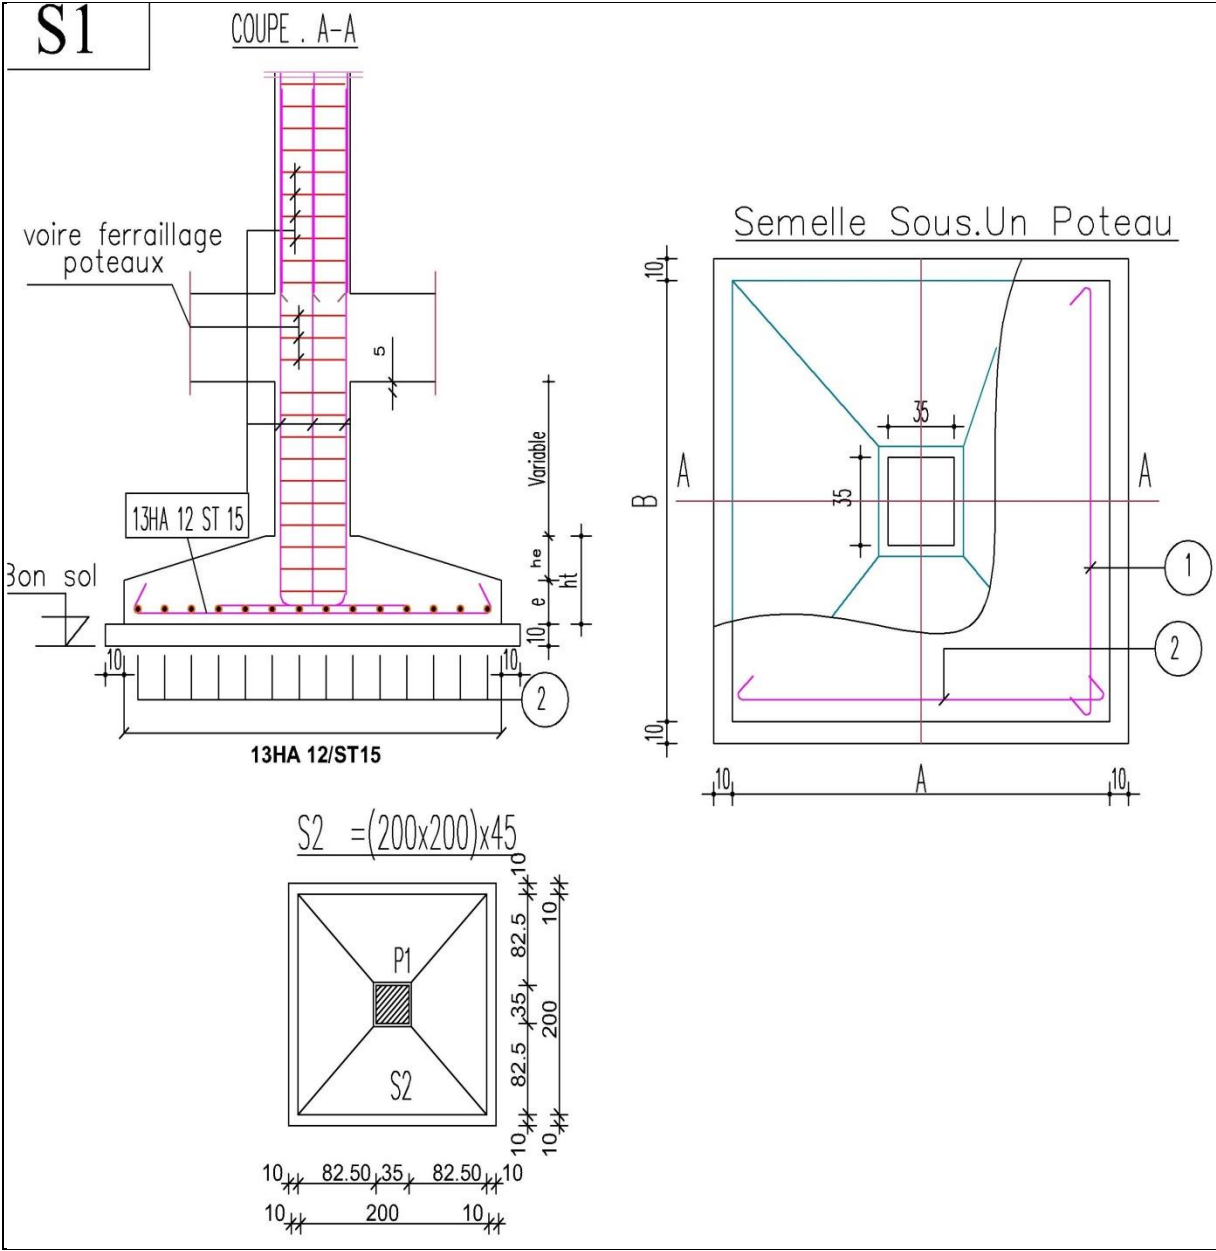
Schéma de ferrailage de la semelle isolée S1
